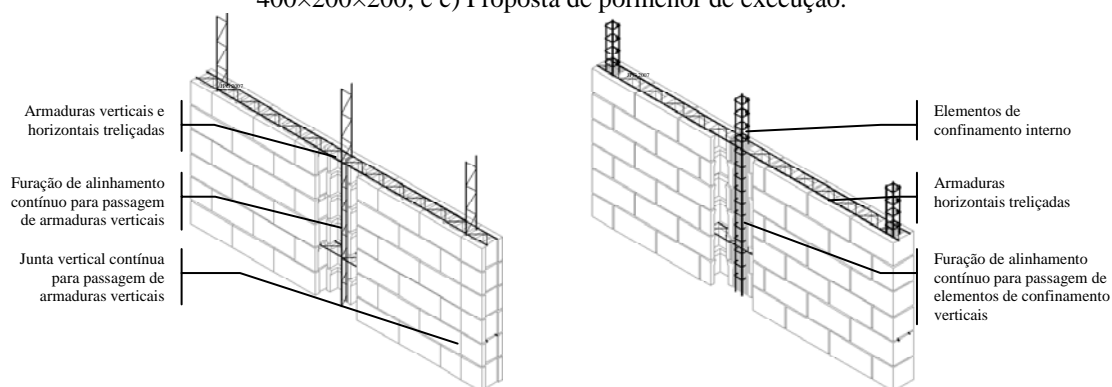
Pormenores de colocação de armaduras e alinhamentos verticais para esse efeito.
